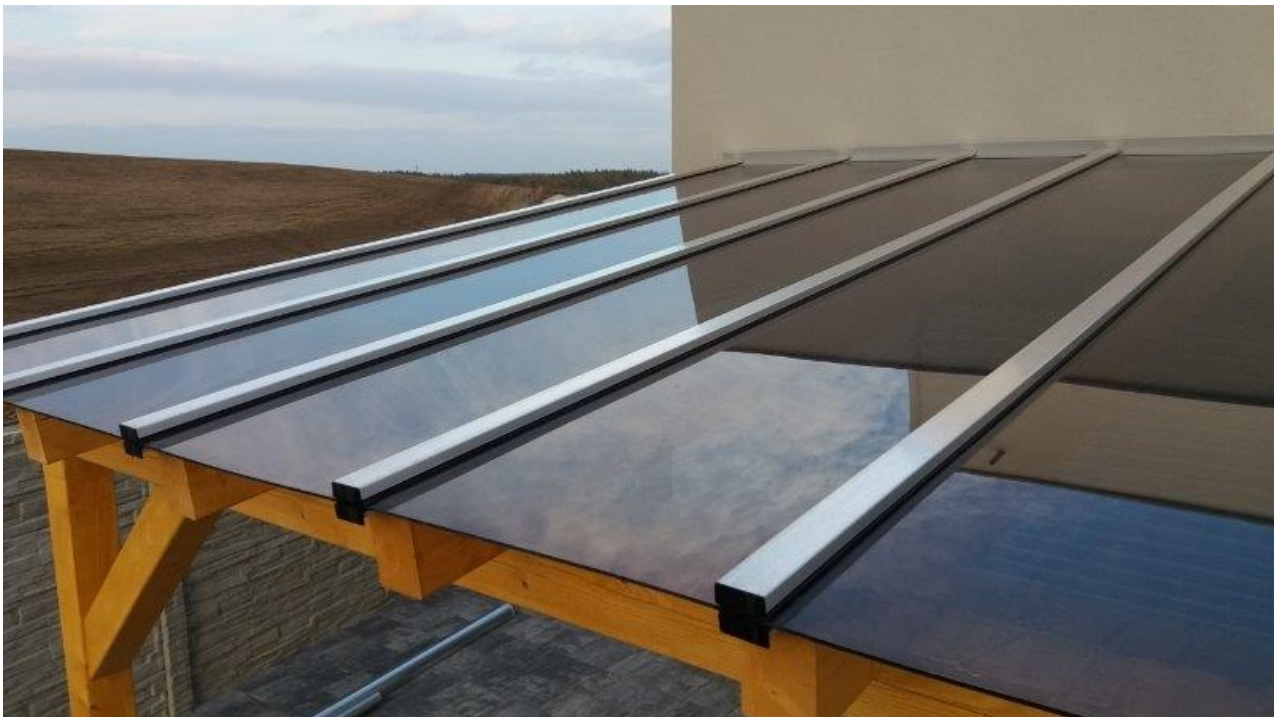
Pohled na dokončený přístřešek, upevňovací profily jsou doplněny čelními krytkami.
